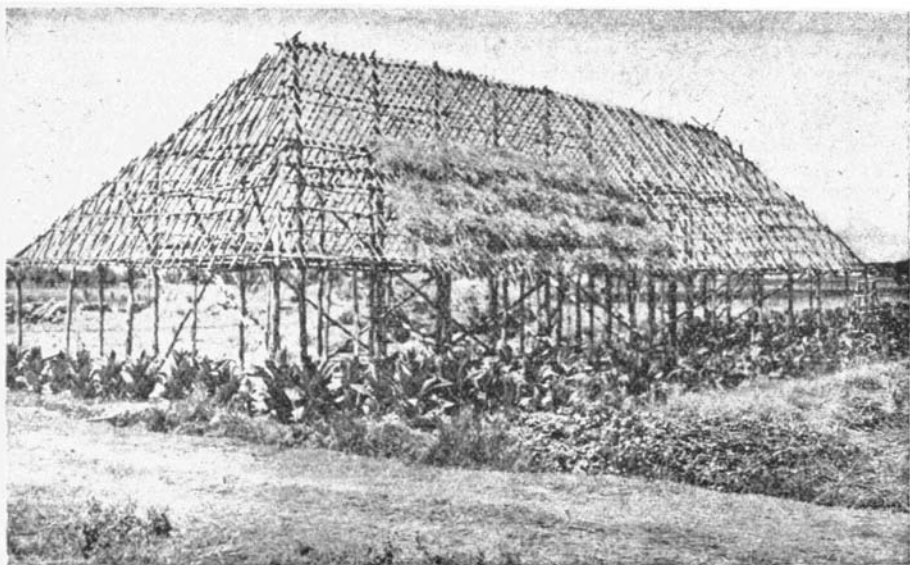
Esqueleto, detalle de la armadura de cubierta de madera rolliza de chopo, y aspecto exterior una vez recubierto con los empajados, de un secadero, con el que por la fuerte pendiente de la cubierta y el aislamiento del medio exterior proporcionado, por la gruesa capa de paja, se obtienen positivos resultados en algunos términos municipales de la vega de Granada.
